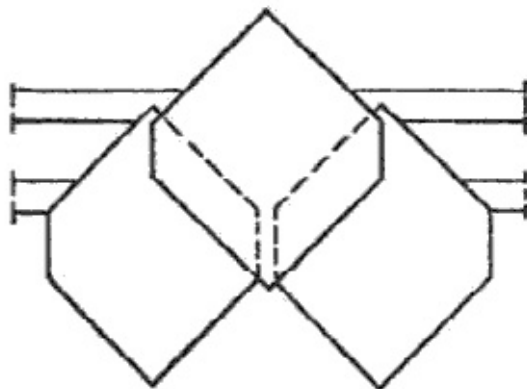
Фрагмент наружной облицовки асбестоцементными плитками
